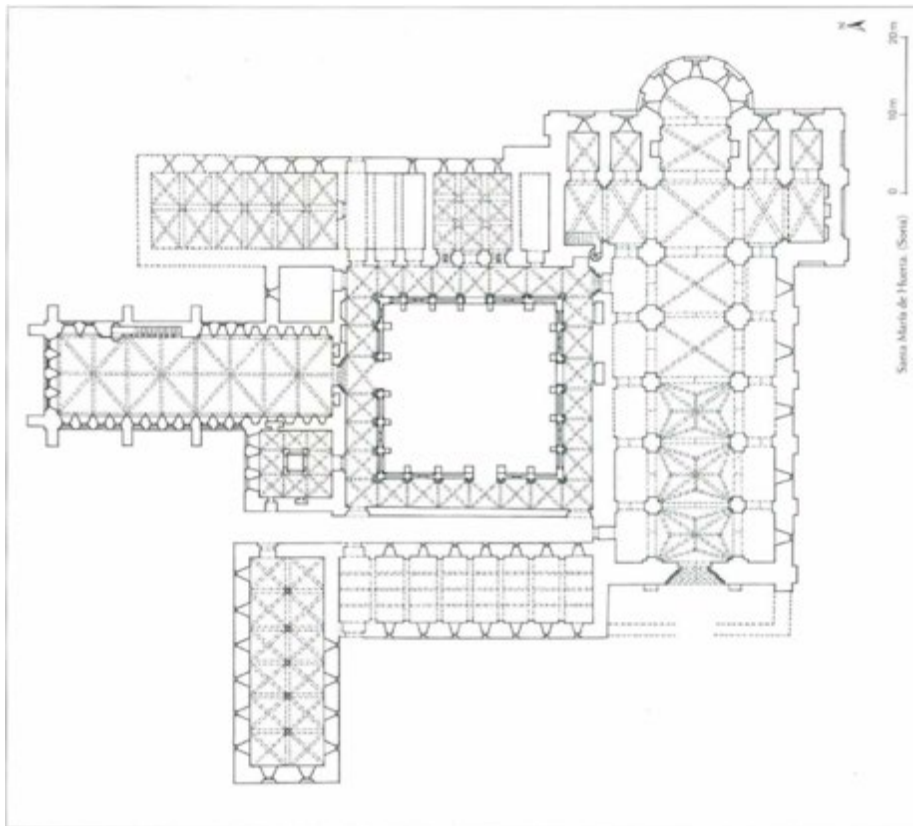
Huerta, Santa María la Real, Grundriss Kirche und Kloster.
